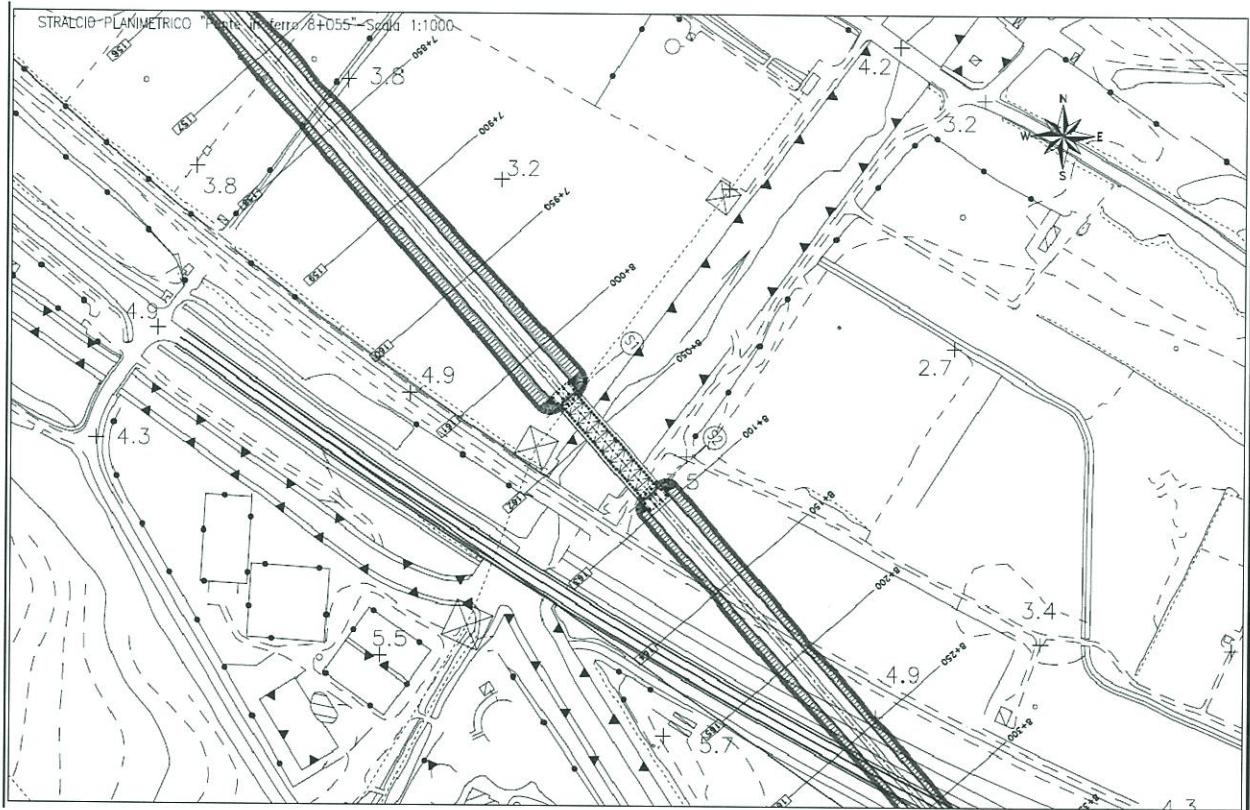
Travata metallica sul collettore "Bonifica di Ramitelli": stralcio planimetrico
